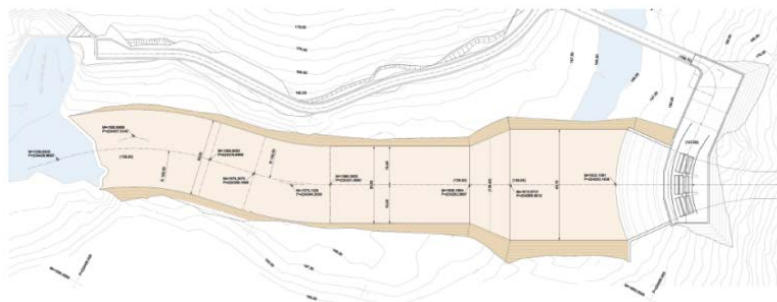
Planta do Canal de Restituição, (EDP, 2010).
